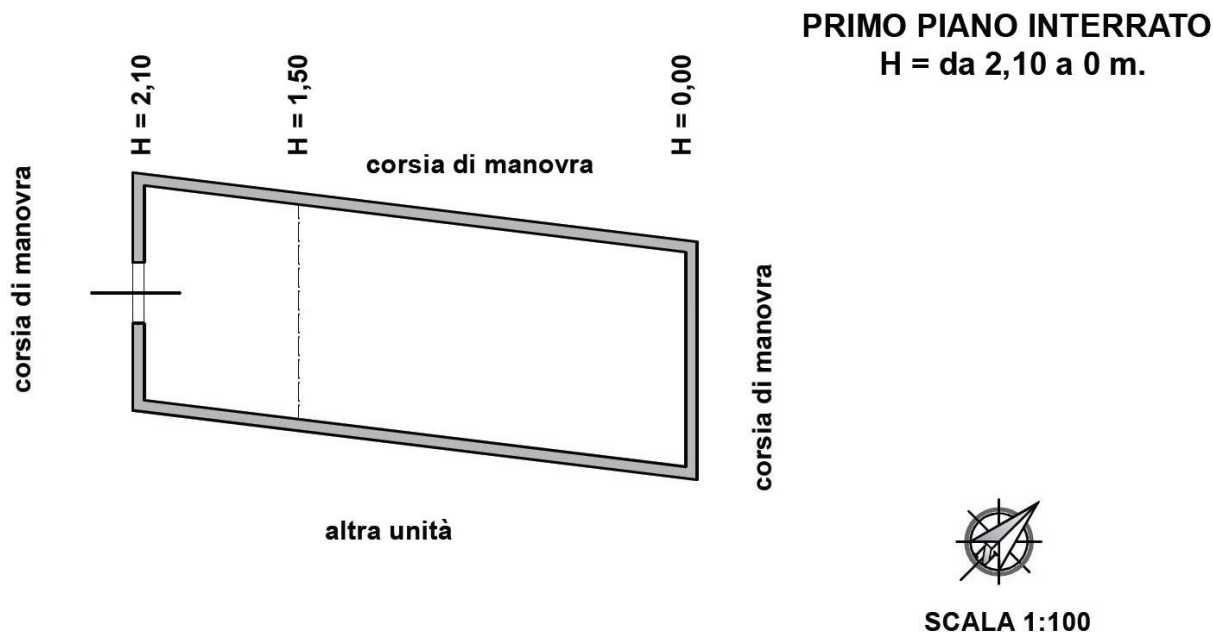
LOTTO 13 – Planimetria locale deposito foglio 76 – part. 620 – sub. 184
